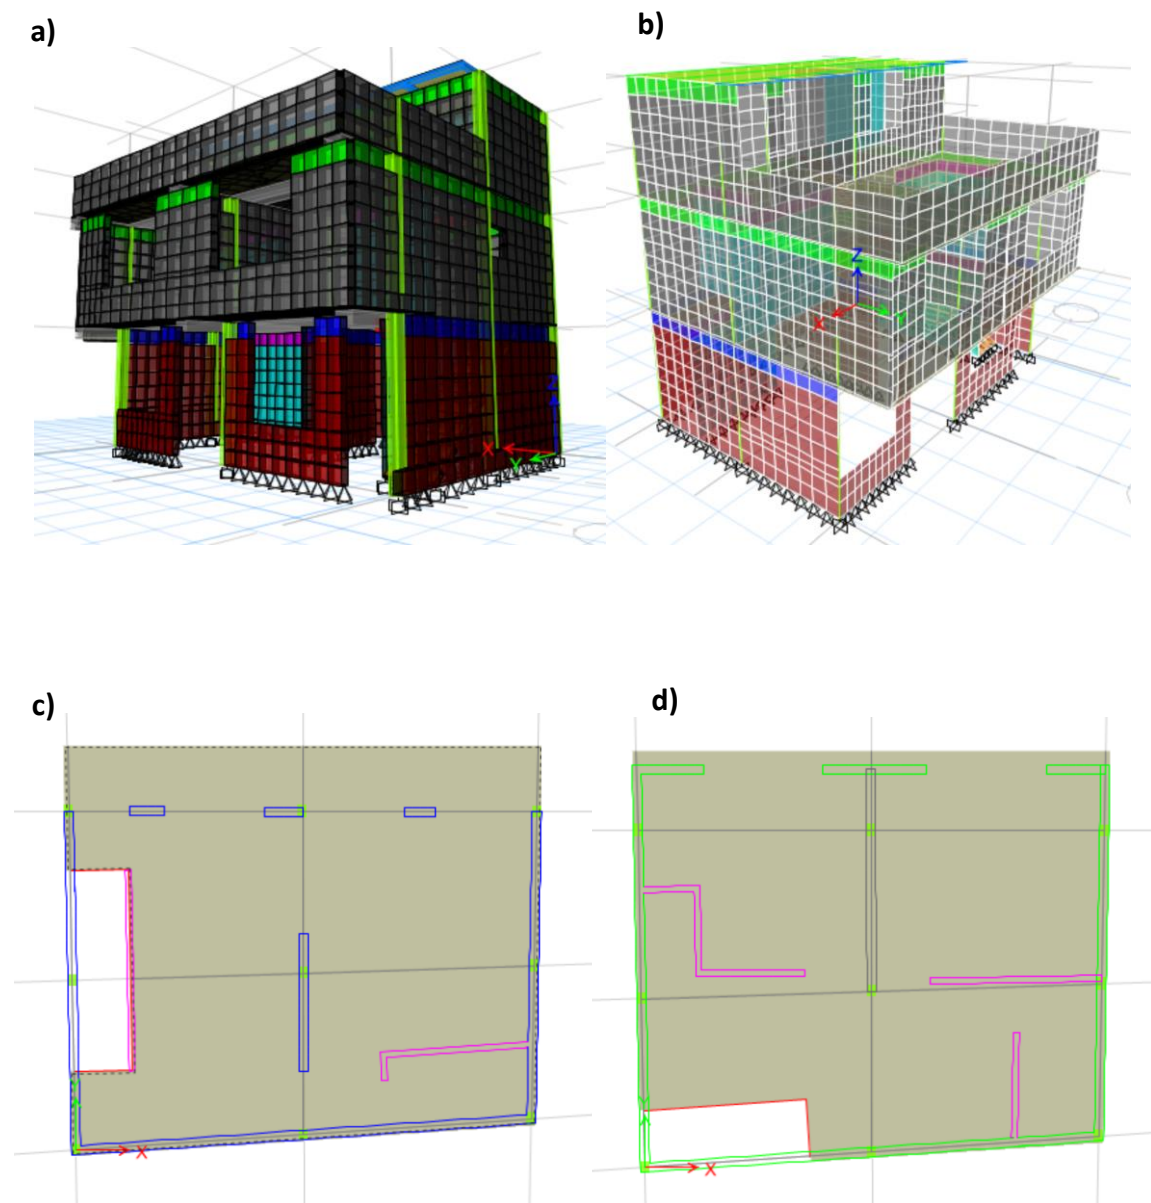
Elementos Pier y Spandrel en primera planta, Modelo 1*Figura 132*Elementos Pier y Spandrel en segunda planta, Modelo 1
